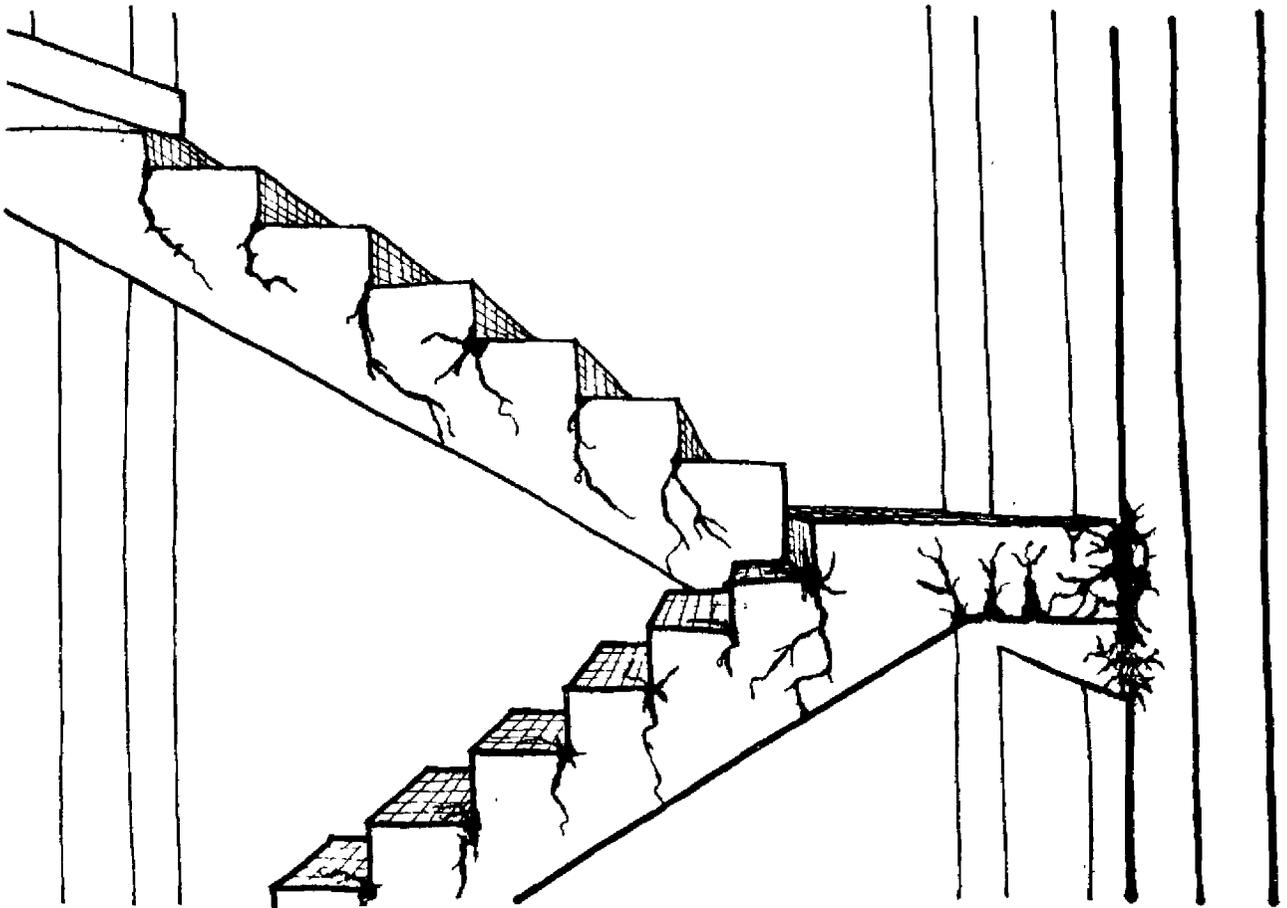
Escaleras más rígidas que los otros elementos estructurales.
